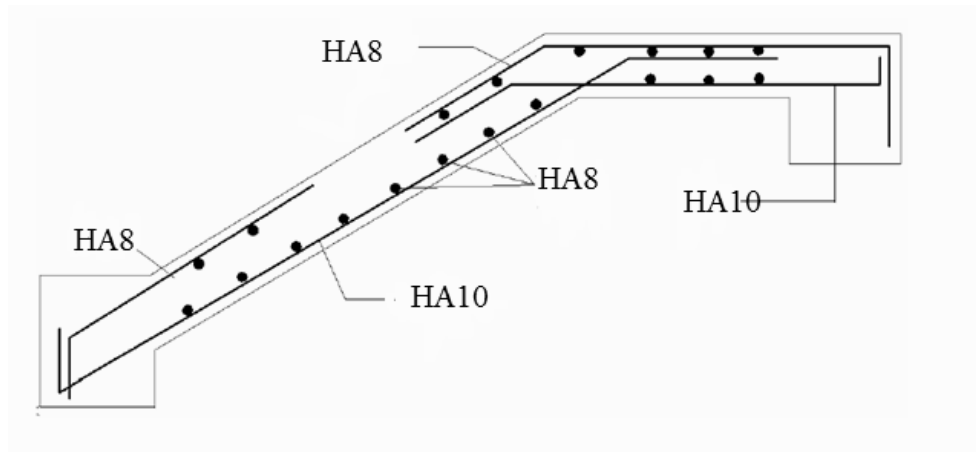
schéma de ferrailage de l'escalier type 1
